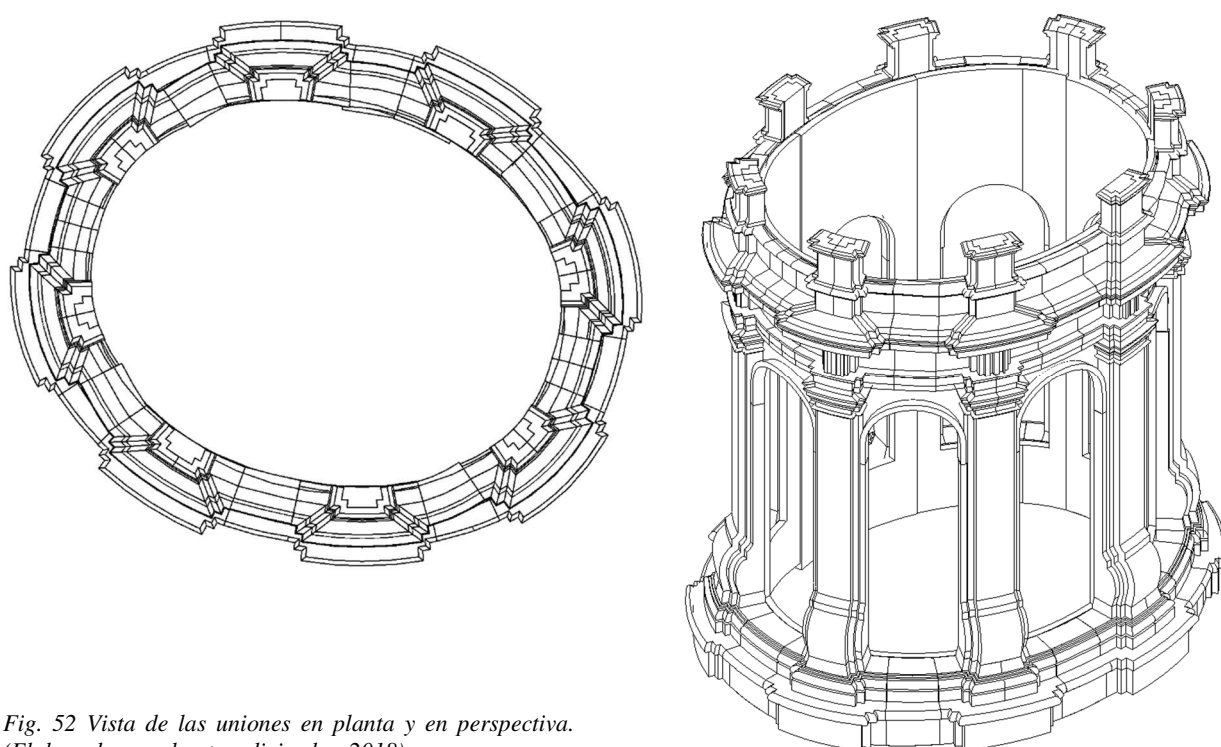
Vista de las uniones en planta y en perspectiva.
